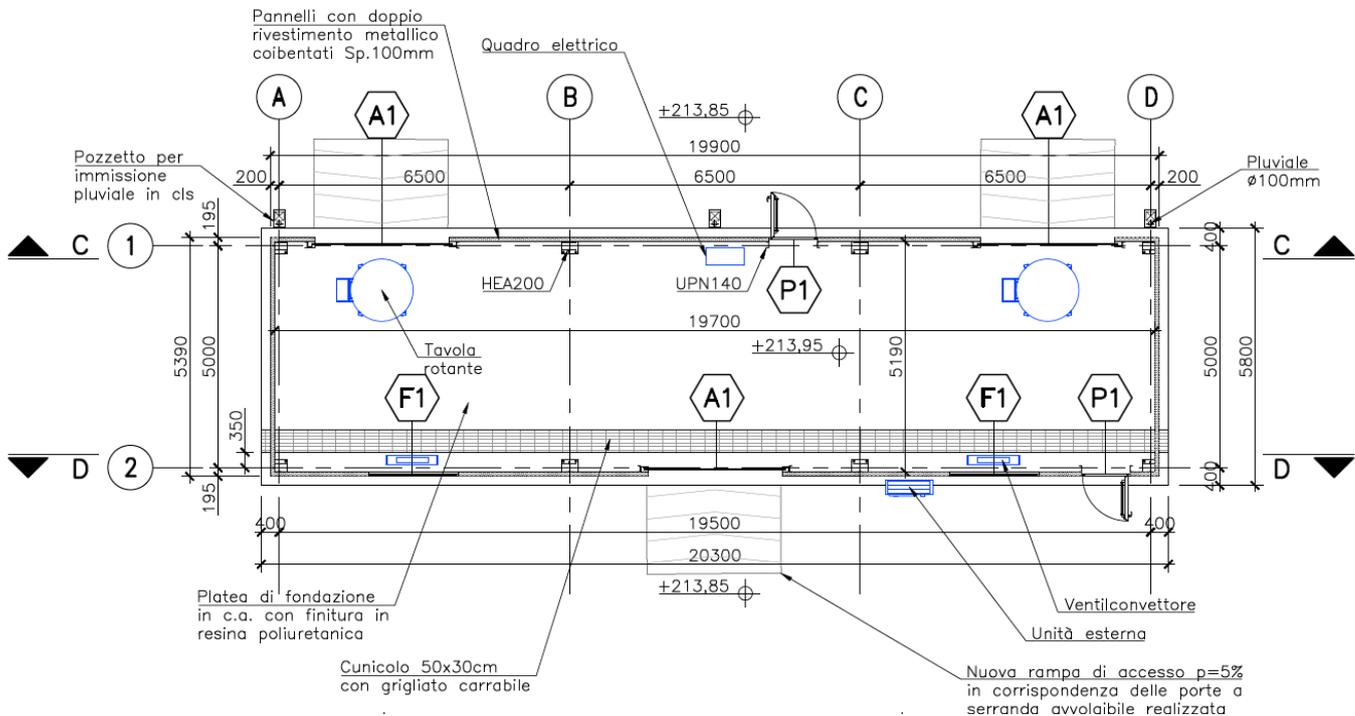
Pianta dell'edificio 21h - Post Operam
